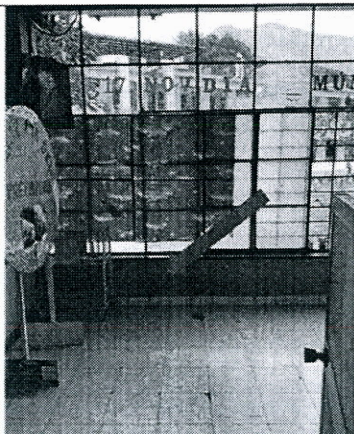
MURETE A DEMOLER Y DESMONTAJE DE VENTANA PARA ACCESO A LA NUEVA RAMPA.
